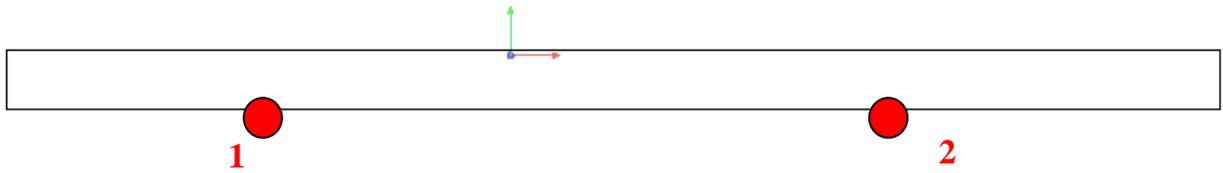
Disposizione dei punti di installazione dei corpi illuminanti su strada perimetrale parco fotovoltaico
